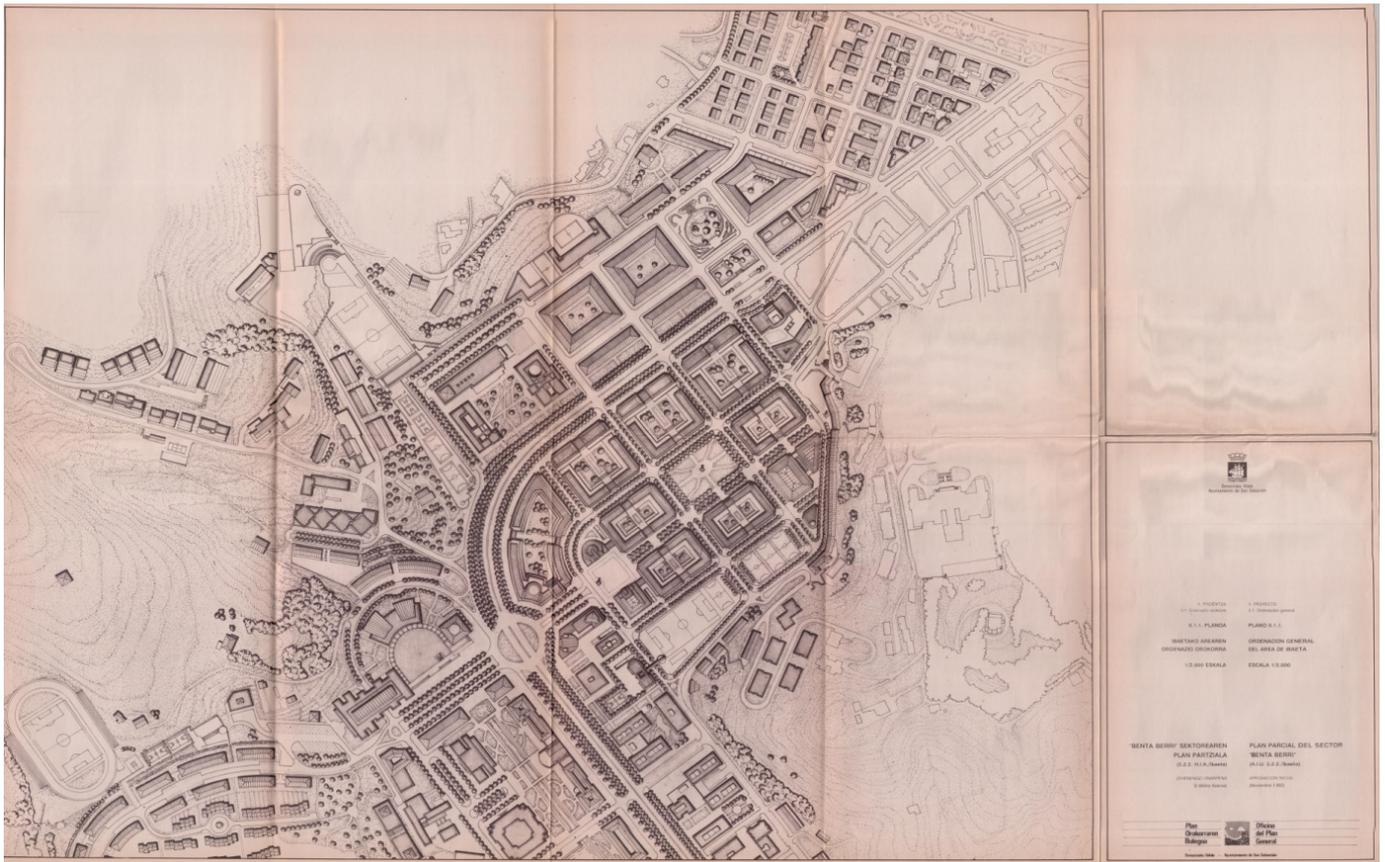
Plano II.1.1. de ordenación general del área de Ibaeta - P.P.O.P.G.
